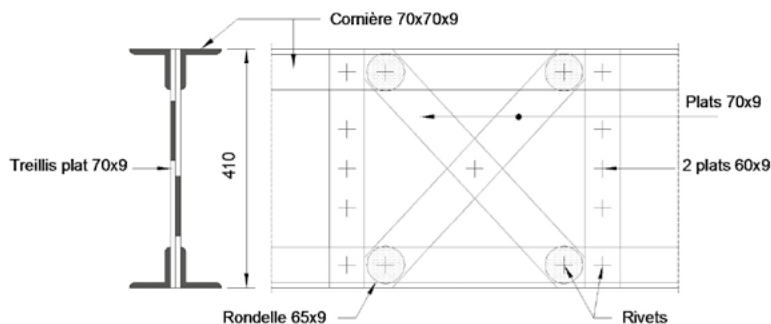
Poutre treillis de faible hauteur (exemple n° 2)
